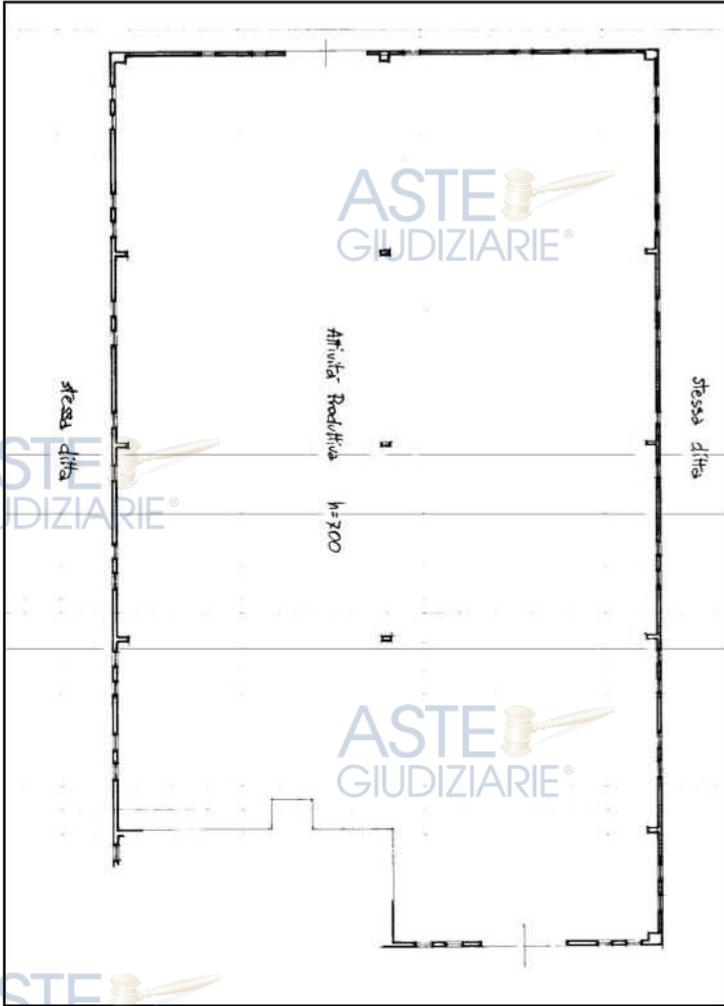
Lotto 3 – Stralcio della planimetria catastale del capannone, sub. 2.
